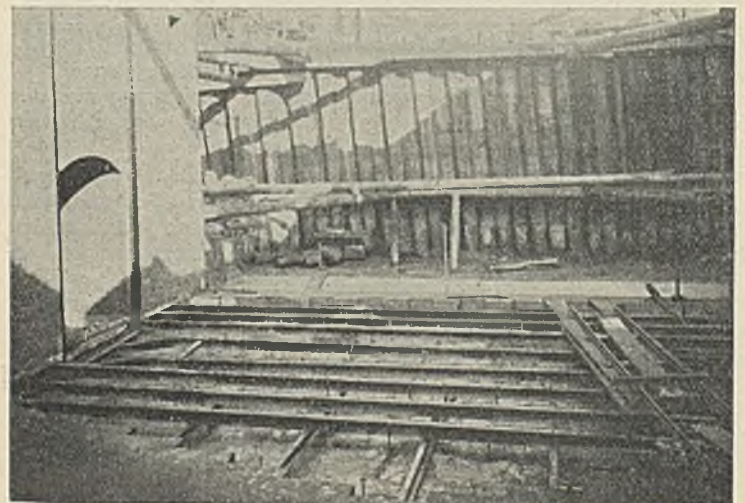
Eiseneinlagen im erhöhten Drempeboden.
